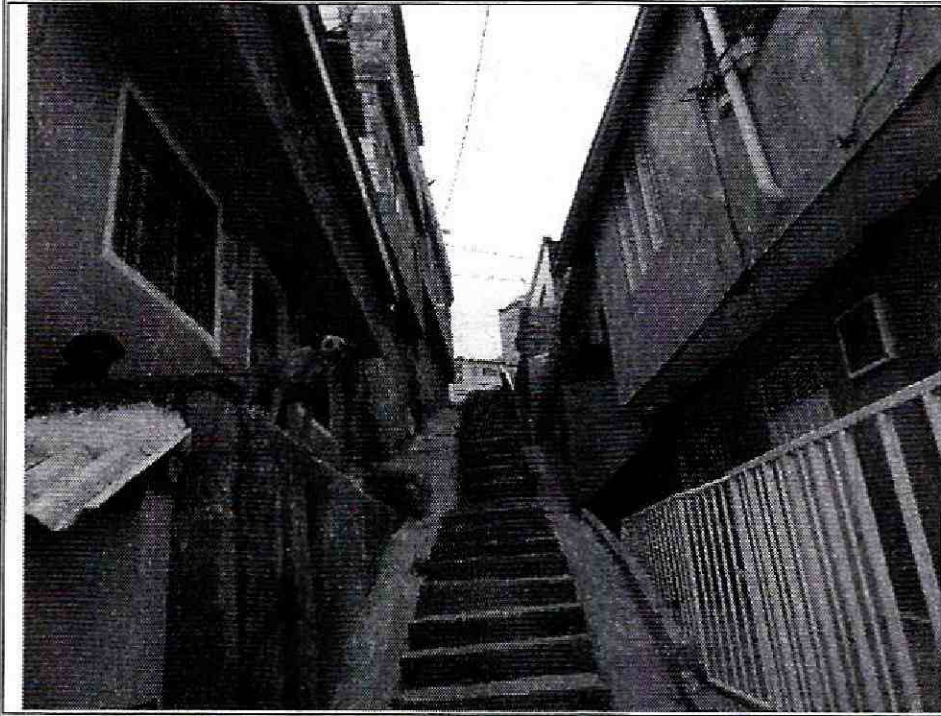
Acceso a la vivienda de la Calle 62 Sur No. 18R-51.
